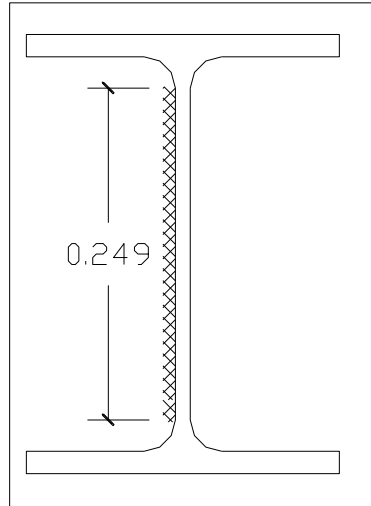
Ubicación de la soldadura a diseñar en el alma de la Viga IPE.
